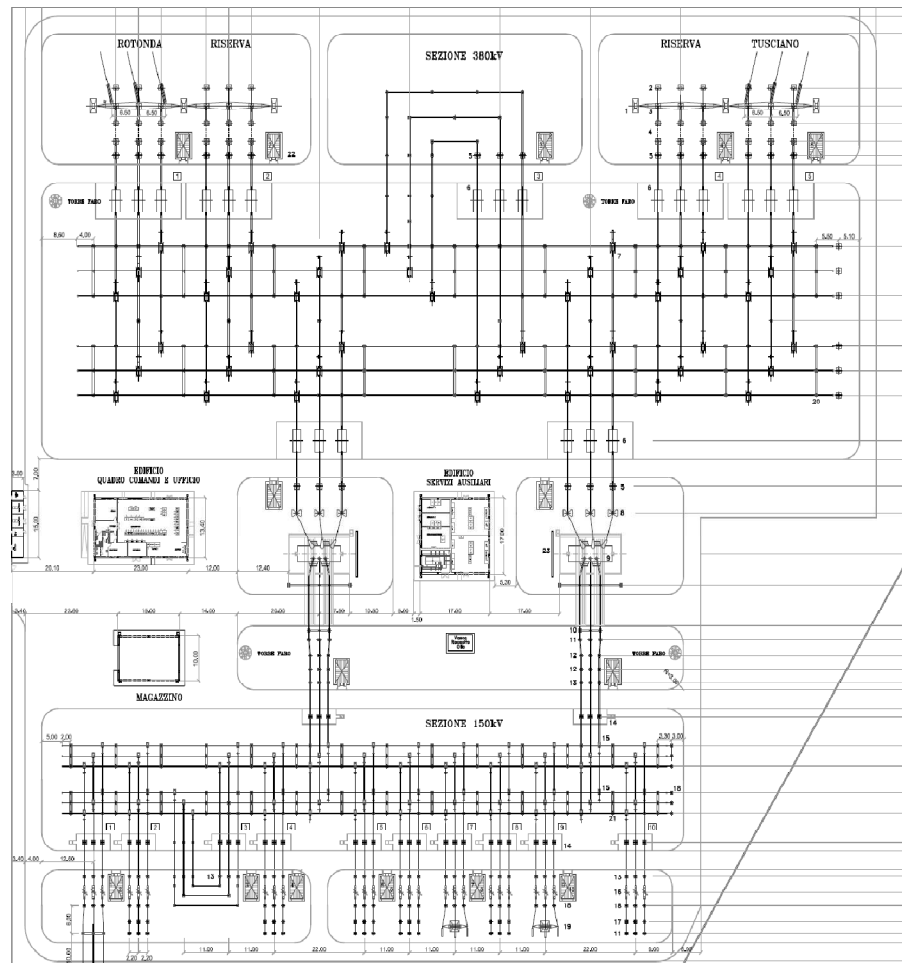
Planimetria elettromeccanica generale - Stazione originaria 380/150 kV
